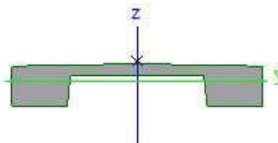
Renderovaný model pro návrh betonářské výztuže
